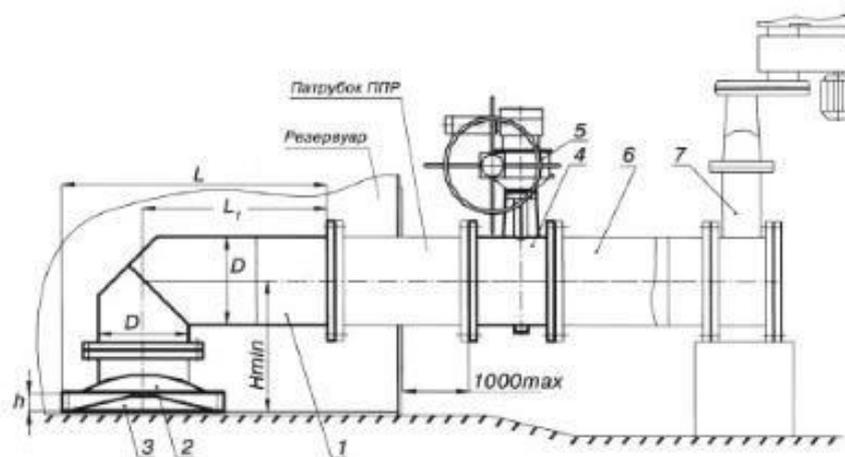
Схема приемо-раздаточного устройства (ПРУ) [8]
